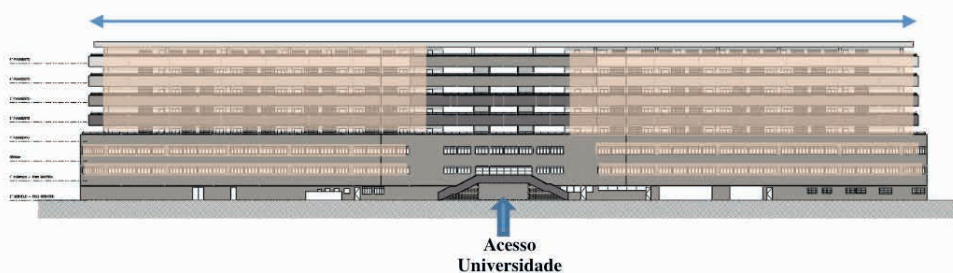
Montagem esquemática indicando as principais características encontradas na Fachada Norte – Rua Ministro de Godói. Fonte: Arquivo FUNDASP com diagramação das autoras.
